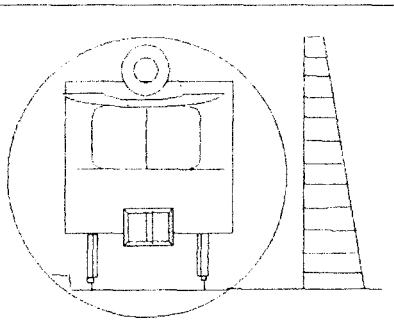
Сечение тоннеля и эпюра ветровой нагрузки
